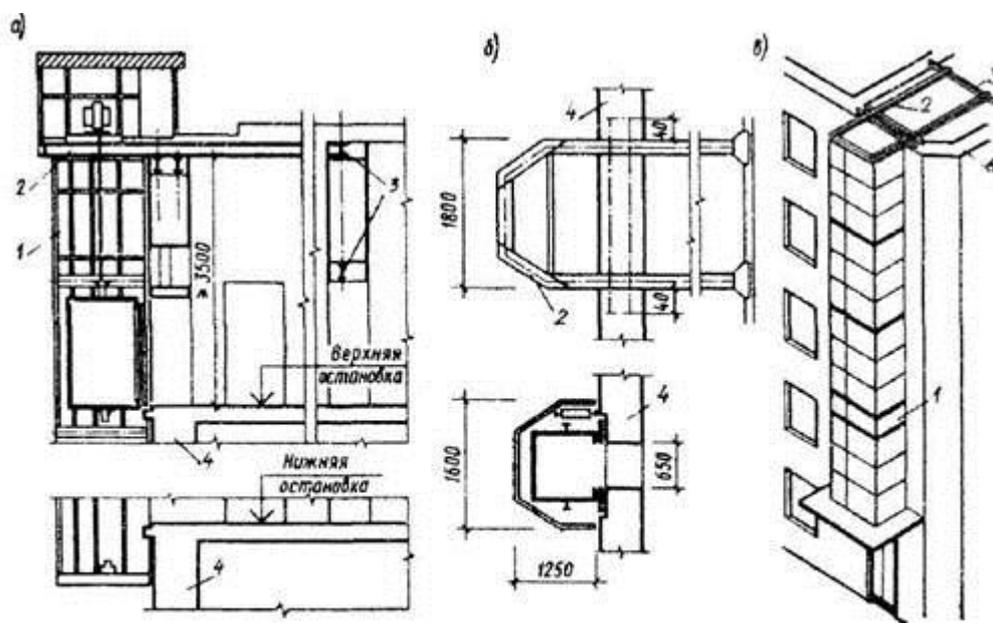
Конструкция наружного подвешного лифта:
